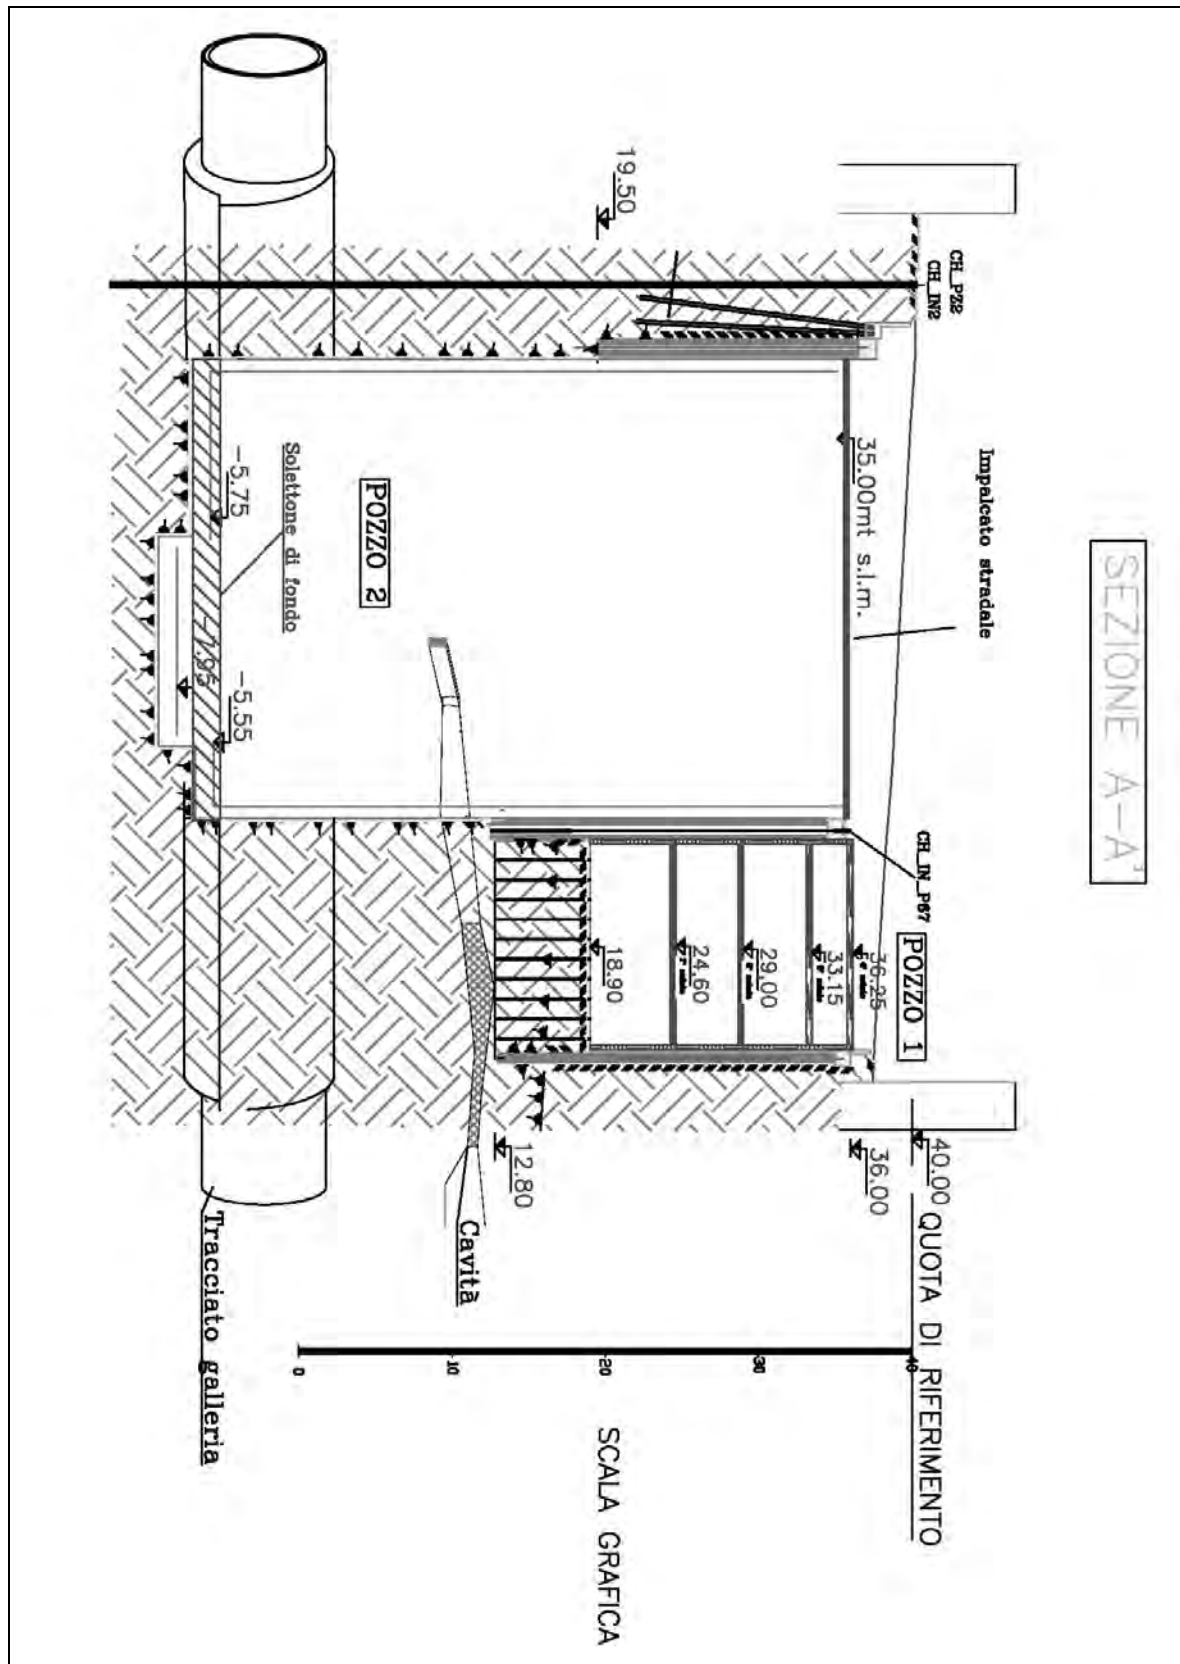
Sezione A-A' pozzo stazione, raffigurante la suddivisione in aree di lavoro.
